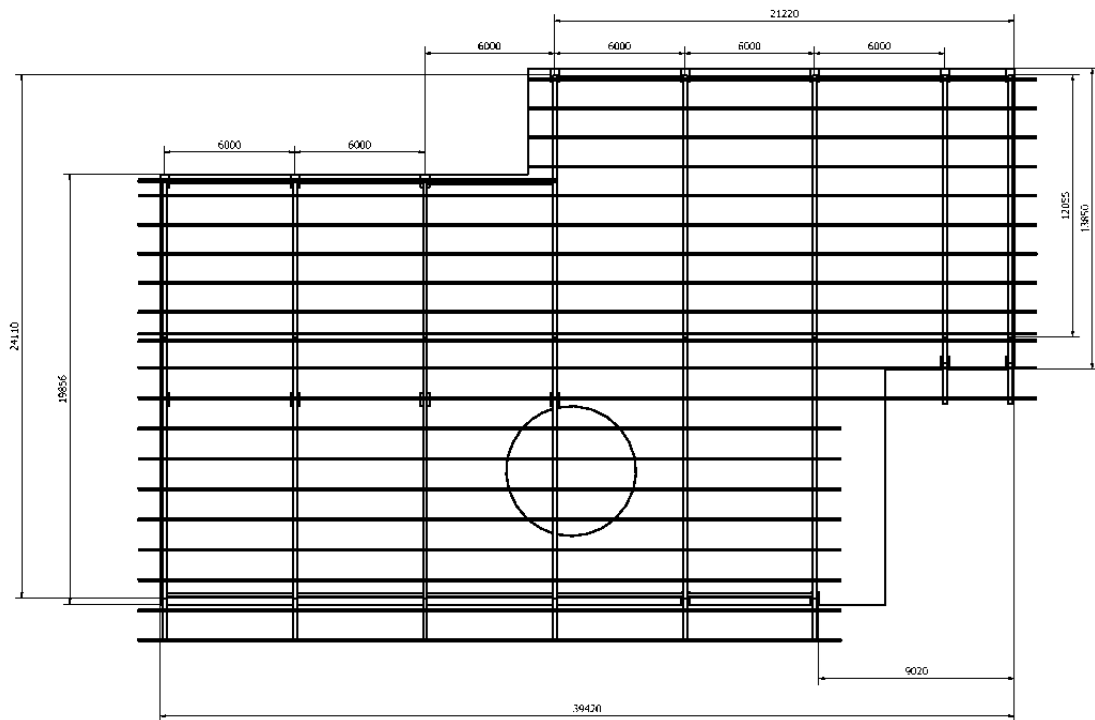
se observa la vista de planta, podemos identificar la forma del terreno donde se instalará la estructura, se puede observar la disposición de las correas y varillas tensoras.
